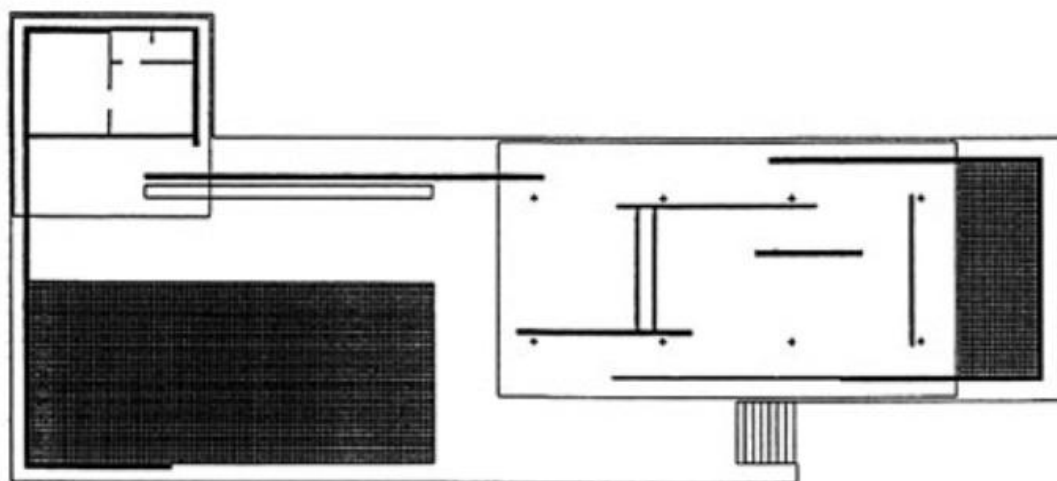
Planta baixa do Pavilhão de Barcelona. (Fonte: PACCARA, M. em Social Design Magazine, 2012).
